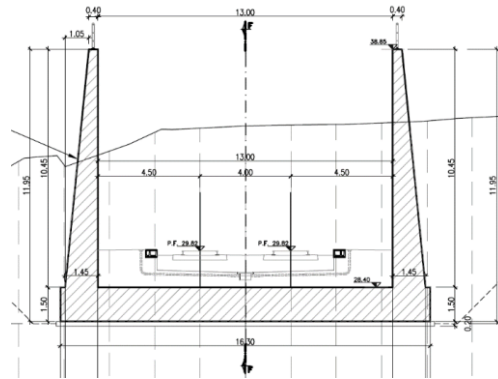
Sezione muro di imbocco ($H_{max}=10.55$ m)
